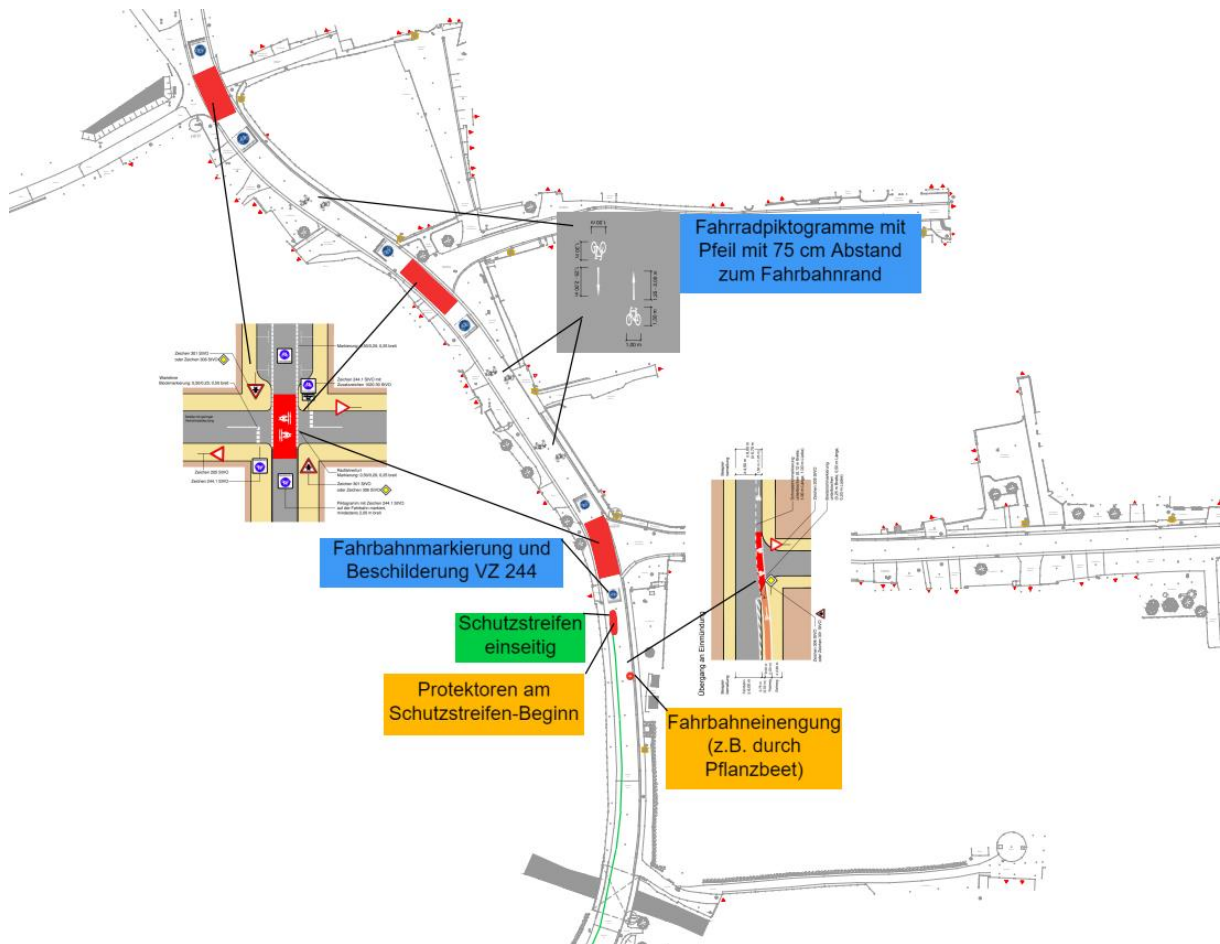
Ausschnitt Planungskizze Fahrradstraße Bad Windsheimer Straße (eigene Darstellung (VAR+, 2023))
